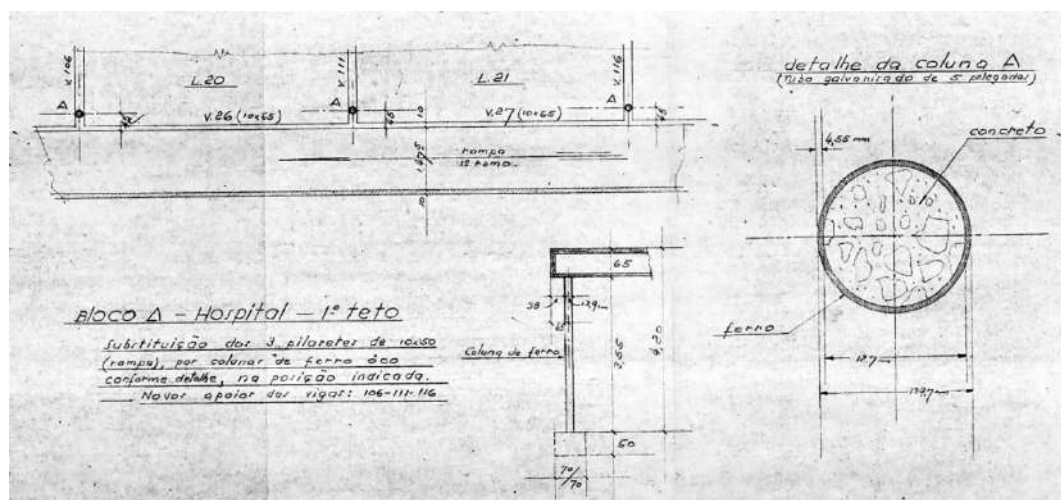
Detalhe de pilar reforçado com tubo de ferro galvanizado. Fonte: NPD-FAU.
